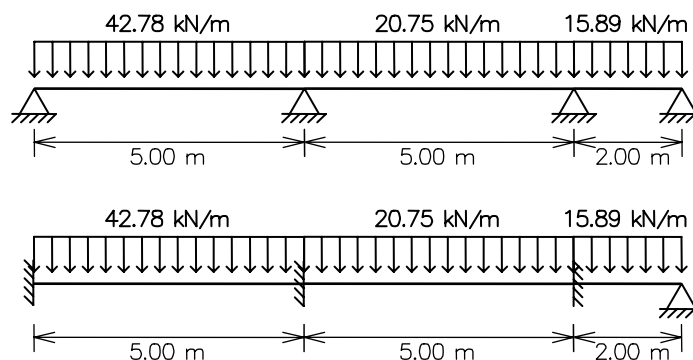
Modelos para viga: apoiado e engastado (Exemplo 4).
